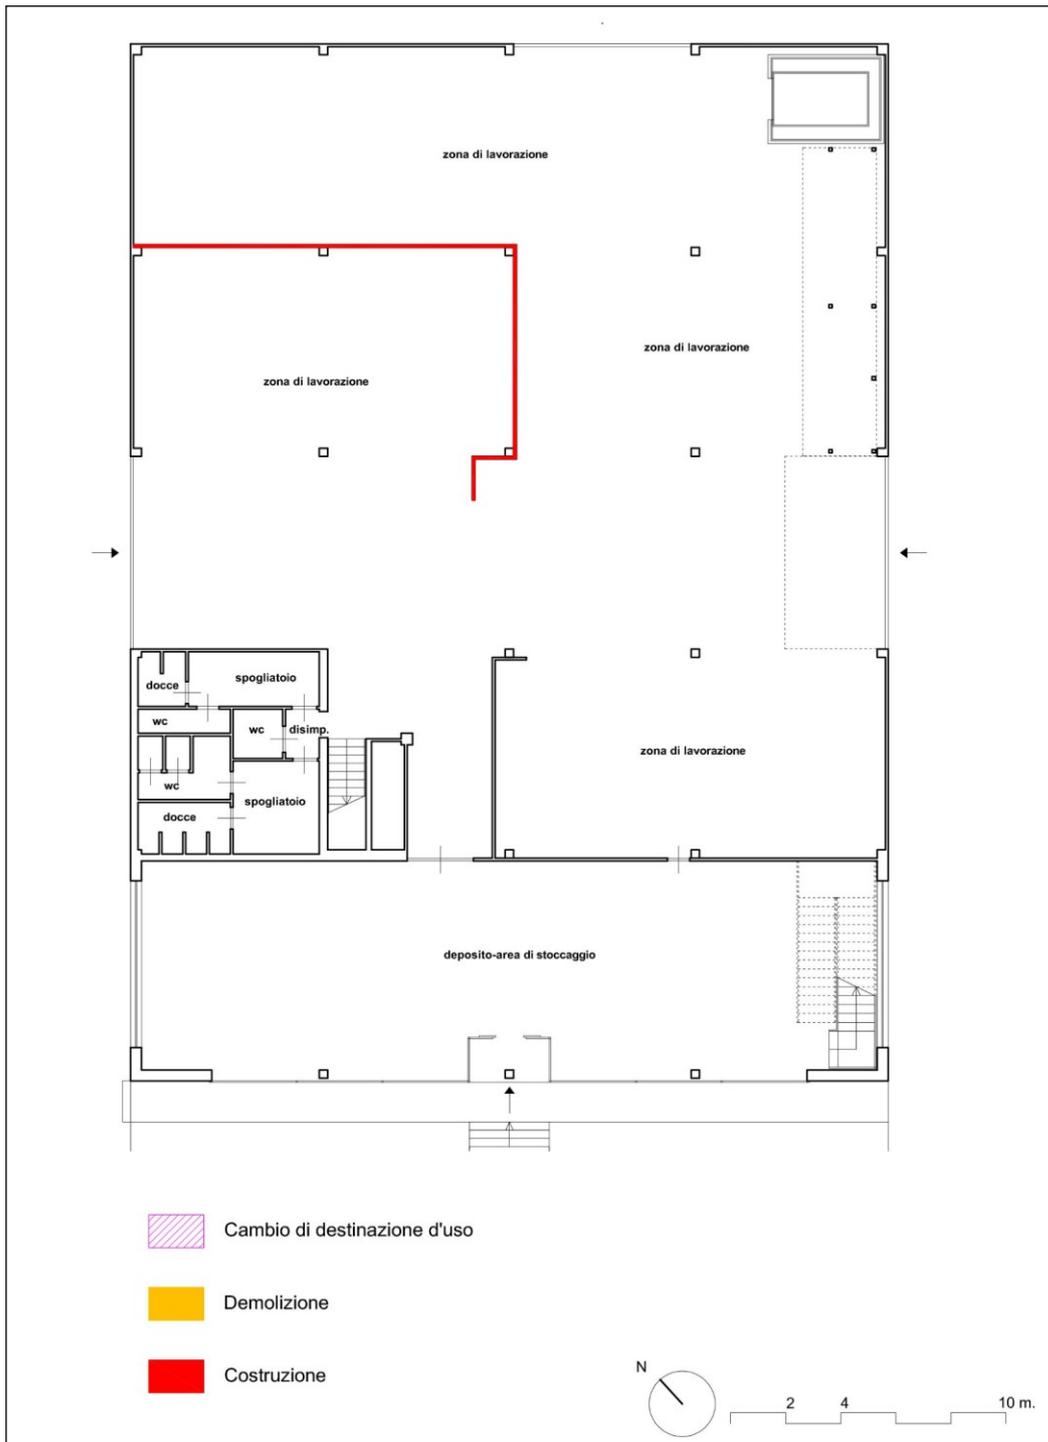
Confronto tra la planimetria catastale e lo stato di fatto. Piano terra.
